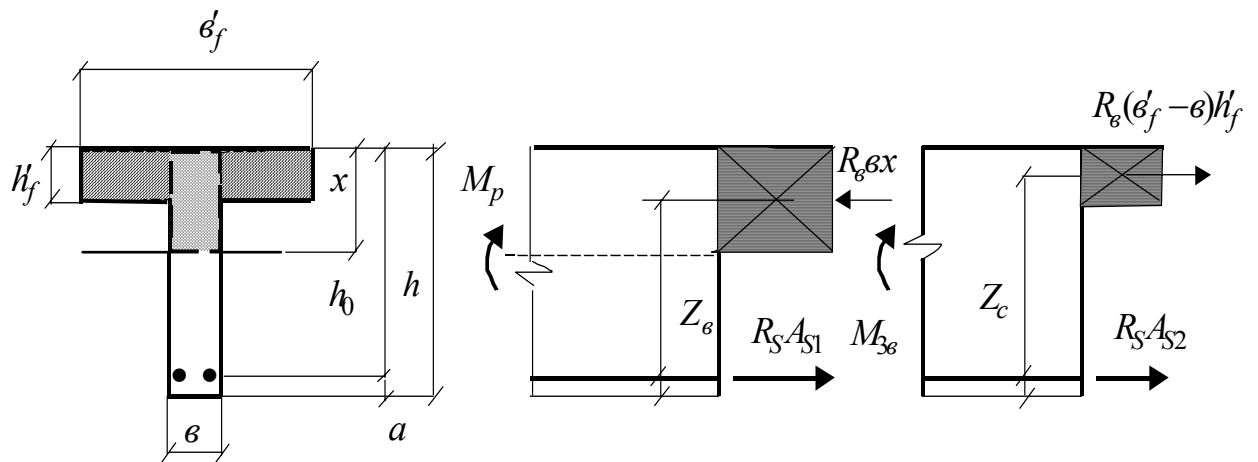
Схема зусиль при розрахунку таврового перерізу за другим випадком
